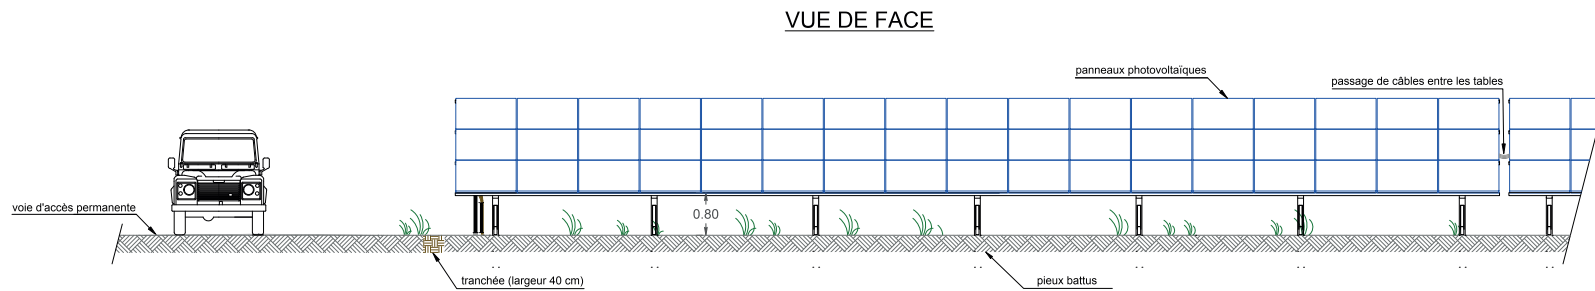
DETAIL - COUPES TRANSVERSALE DES STRUCTURES PHOTOVOLTAIQUES - échelle 1/100e
